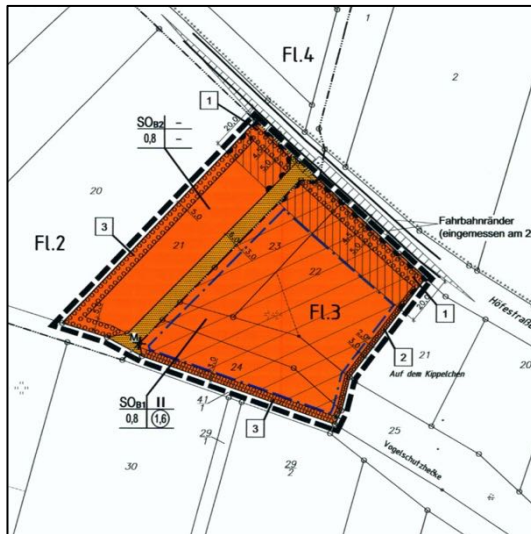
Bebauungsplan „Blockheizkraftwerk“
